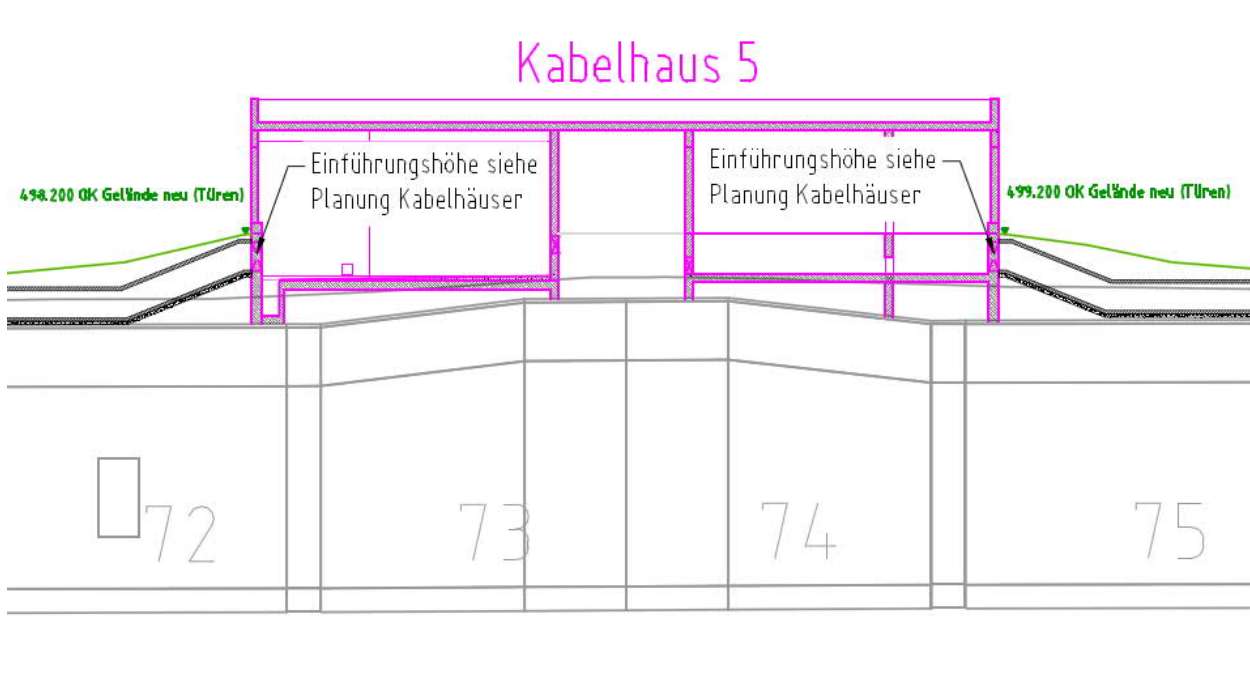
Längsschnitt (SW – NE) des auf der Tunneldecke geplanten Kabelhauses 5 [U 6]. Weitere Details sowie der Grundriss und der Querschnitt sind [U 6] zu entnehmen.
